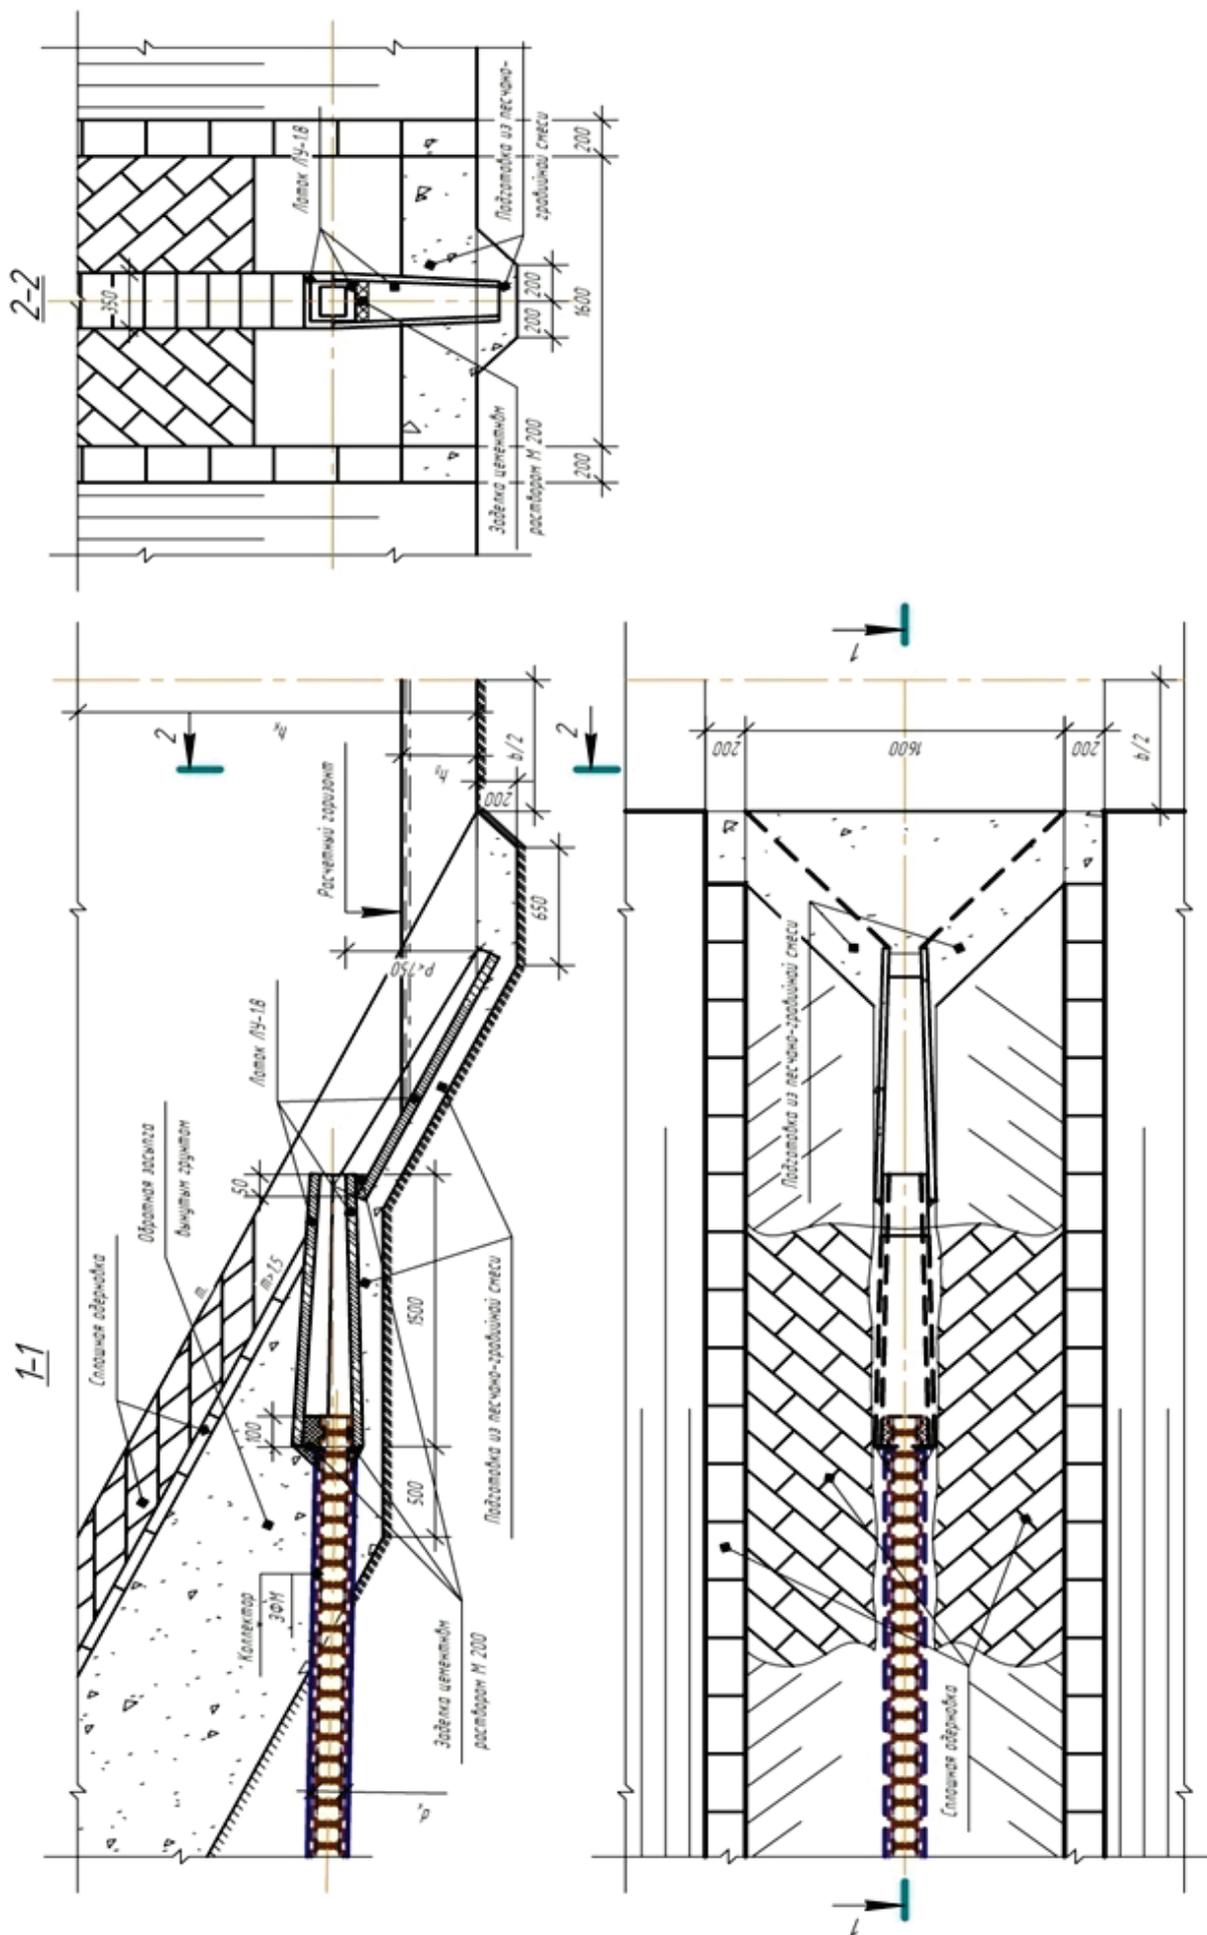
Железобетонное дренажное устьевое сооружение УЛ-1-1.8-75 из корычатых блоков ЛУ-1,8
